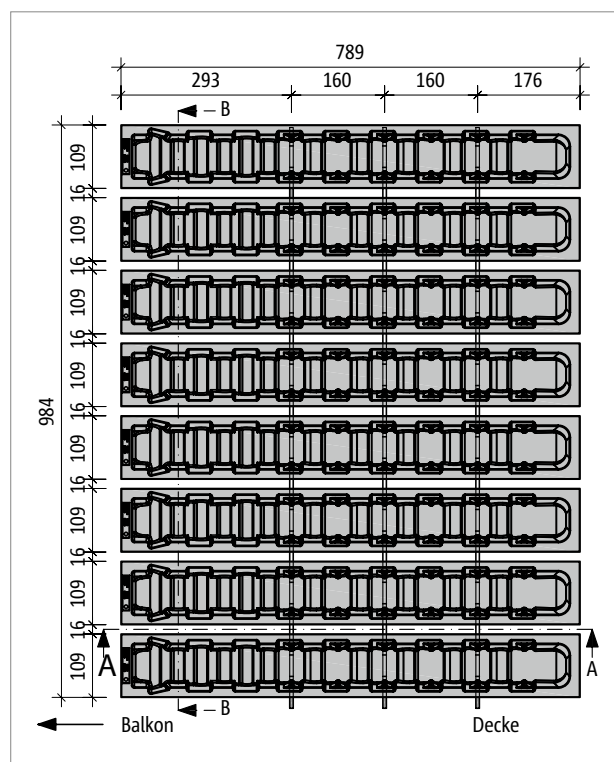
Schöck IDock®: Produktgrundriss IDock2-D
